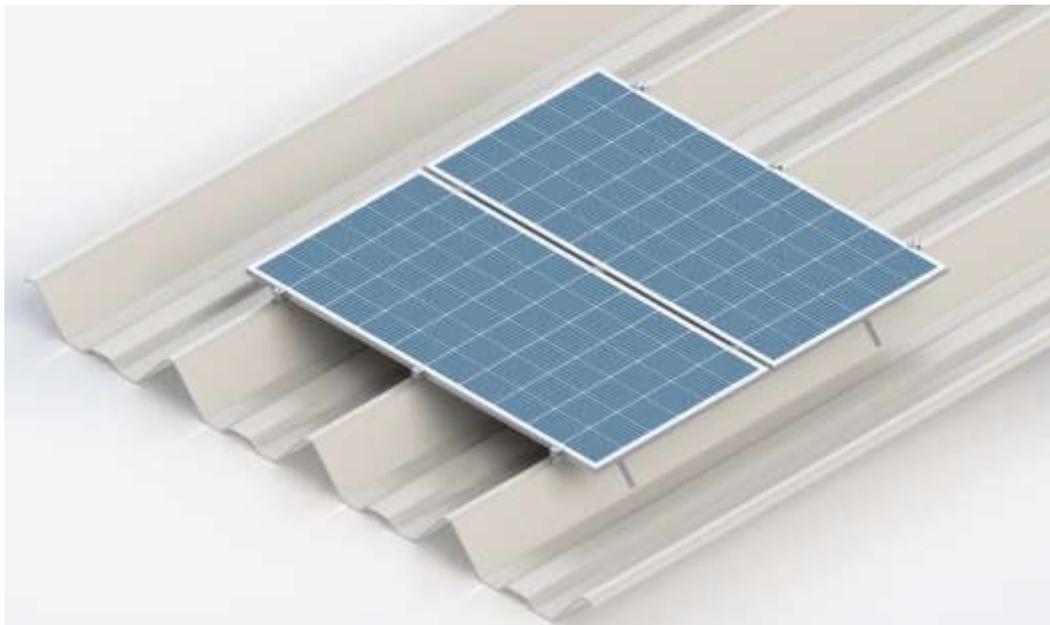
Montagem do Suporte de Fixação para Telhado Calhetão para 2 Módulos – Com os módulos.
